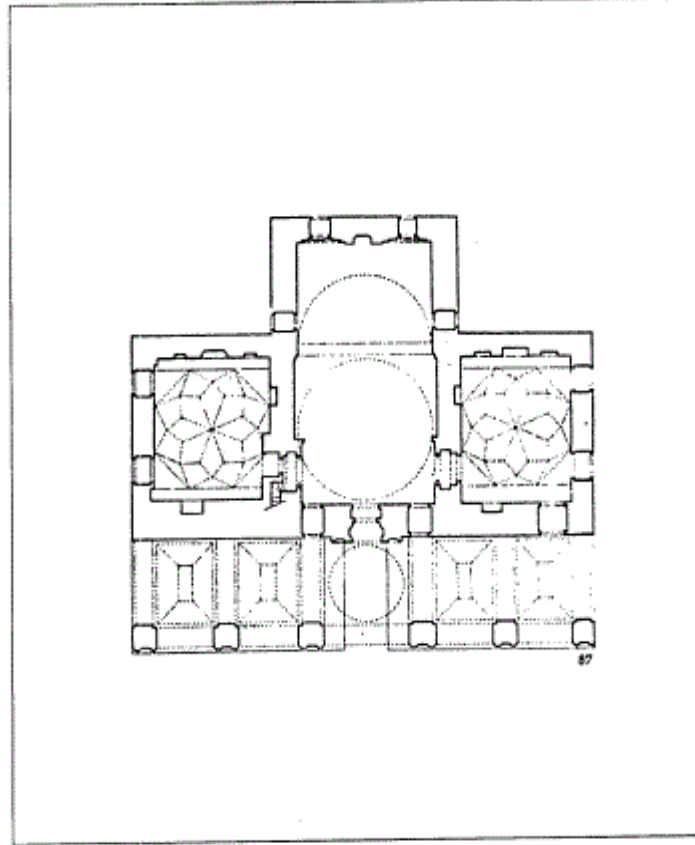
مسقط أفقي لمسجد الفاتحية الصغير في أثينا (عن : اصلان ابا)
